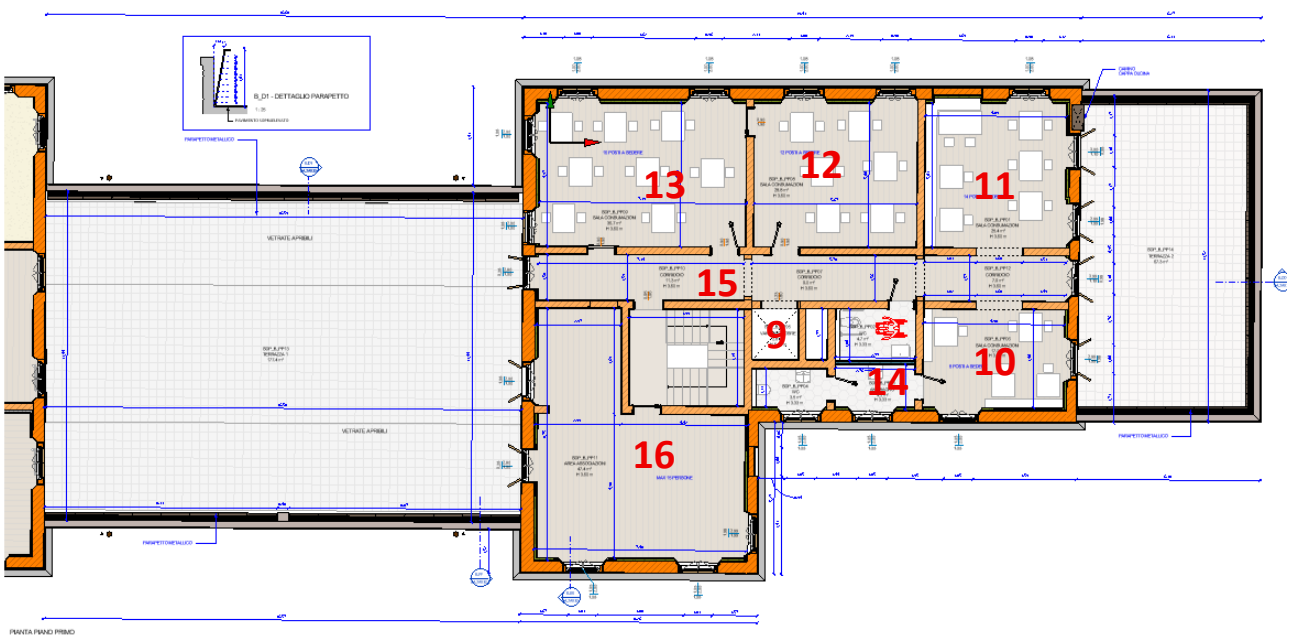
EDIFICIO B - Stato di progetto pianta piano primo.
